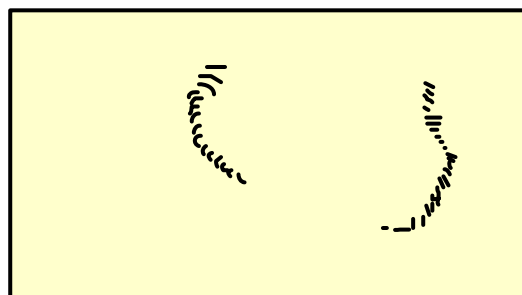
Infiltração em parede – Adaptada de VERÇOZA, 1991
